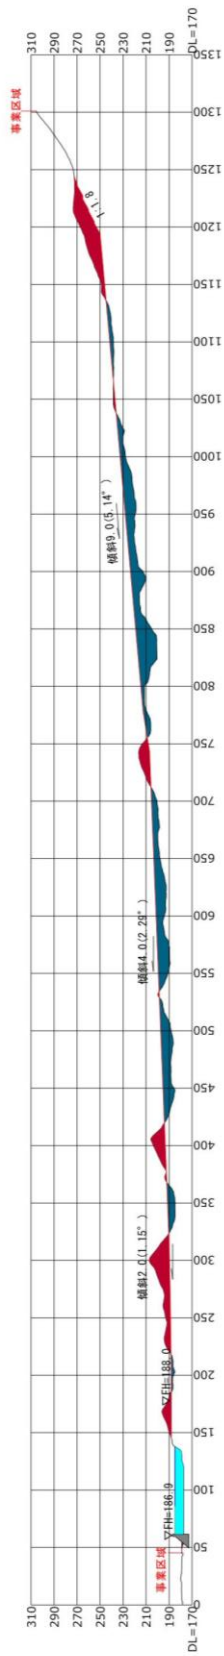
(4) 切土・盛土計画断面図 (E4-E4' 断面)
